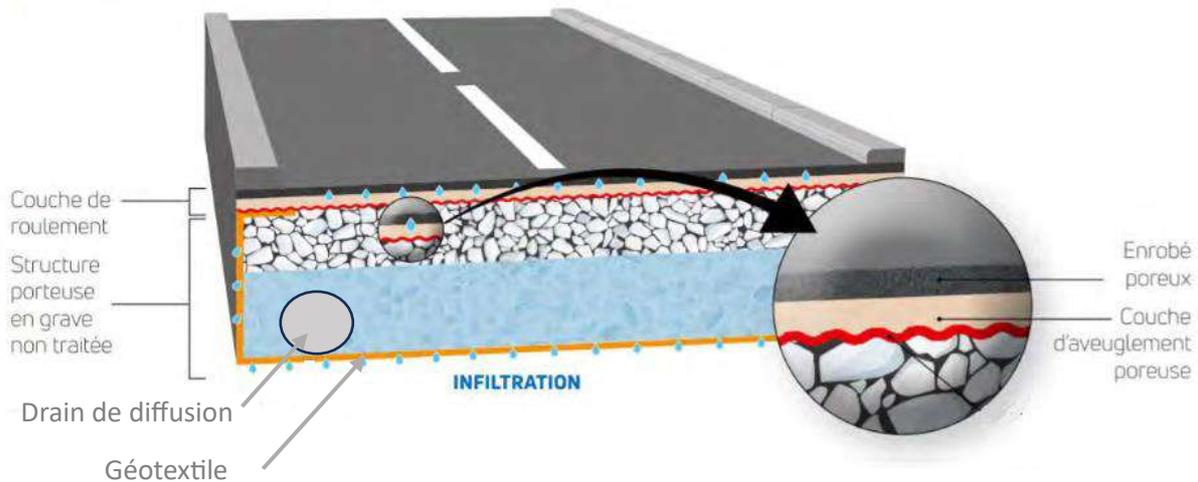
Coupe et exemple de parking en grave drainante.
